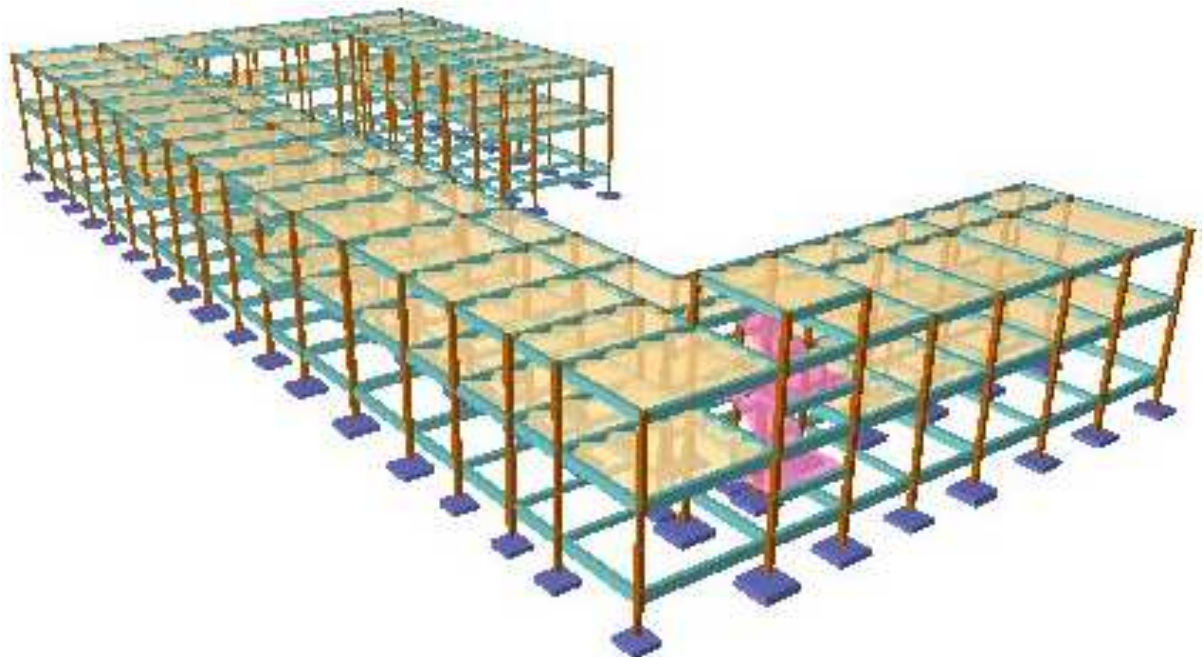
Esquema Estructural; Fuente: Cypecad
